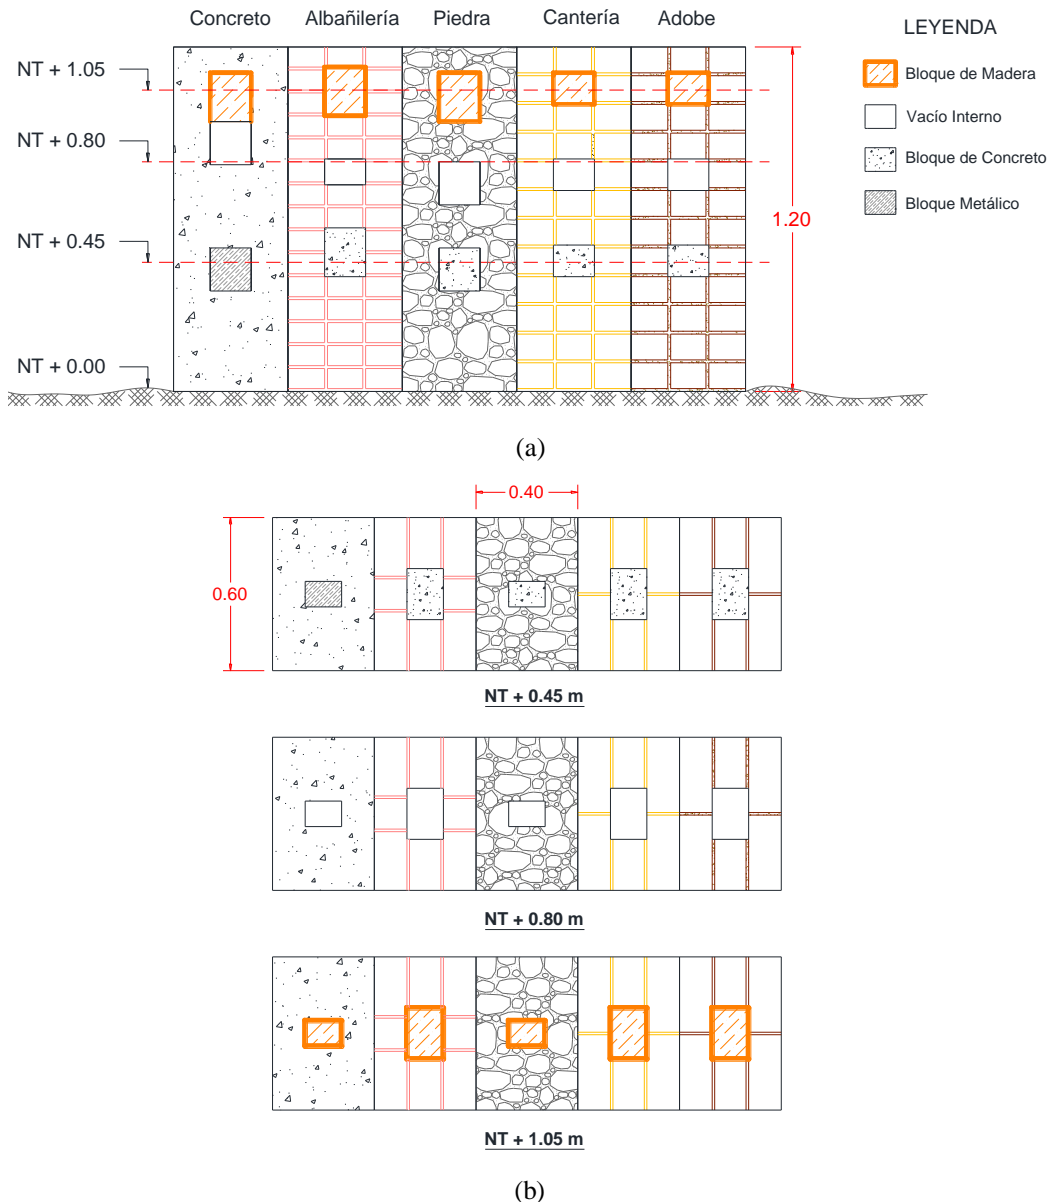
Segundo muro de calibración. (a) sección longitudinal (b) secciones transversales a 0.45, 0.80 y 1.05 m del nivel del terreno.
